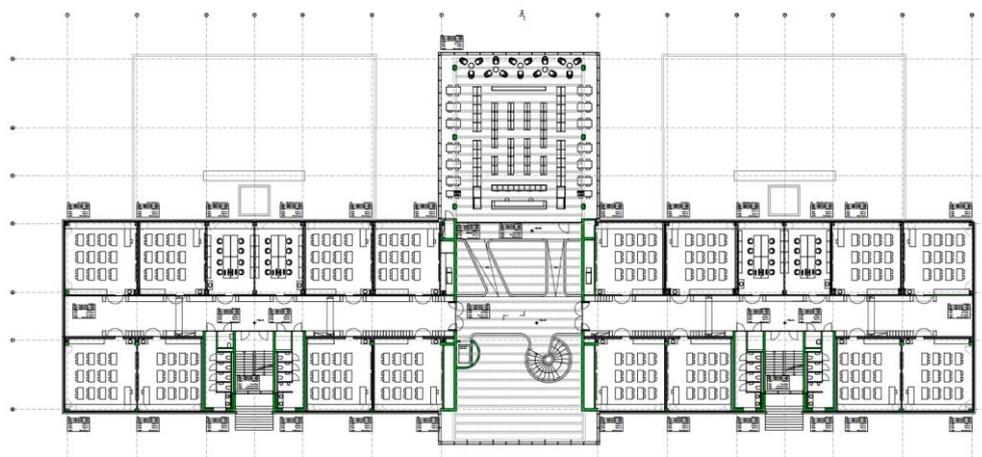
Pianta terzo piano – Durisch + Nolli Architetti sagl
